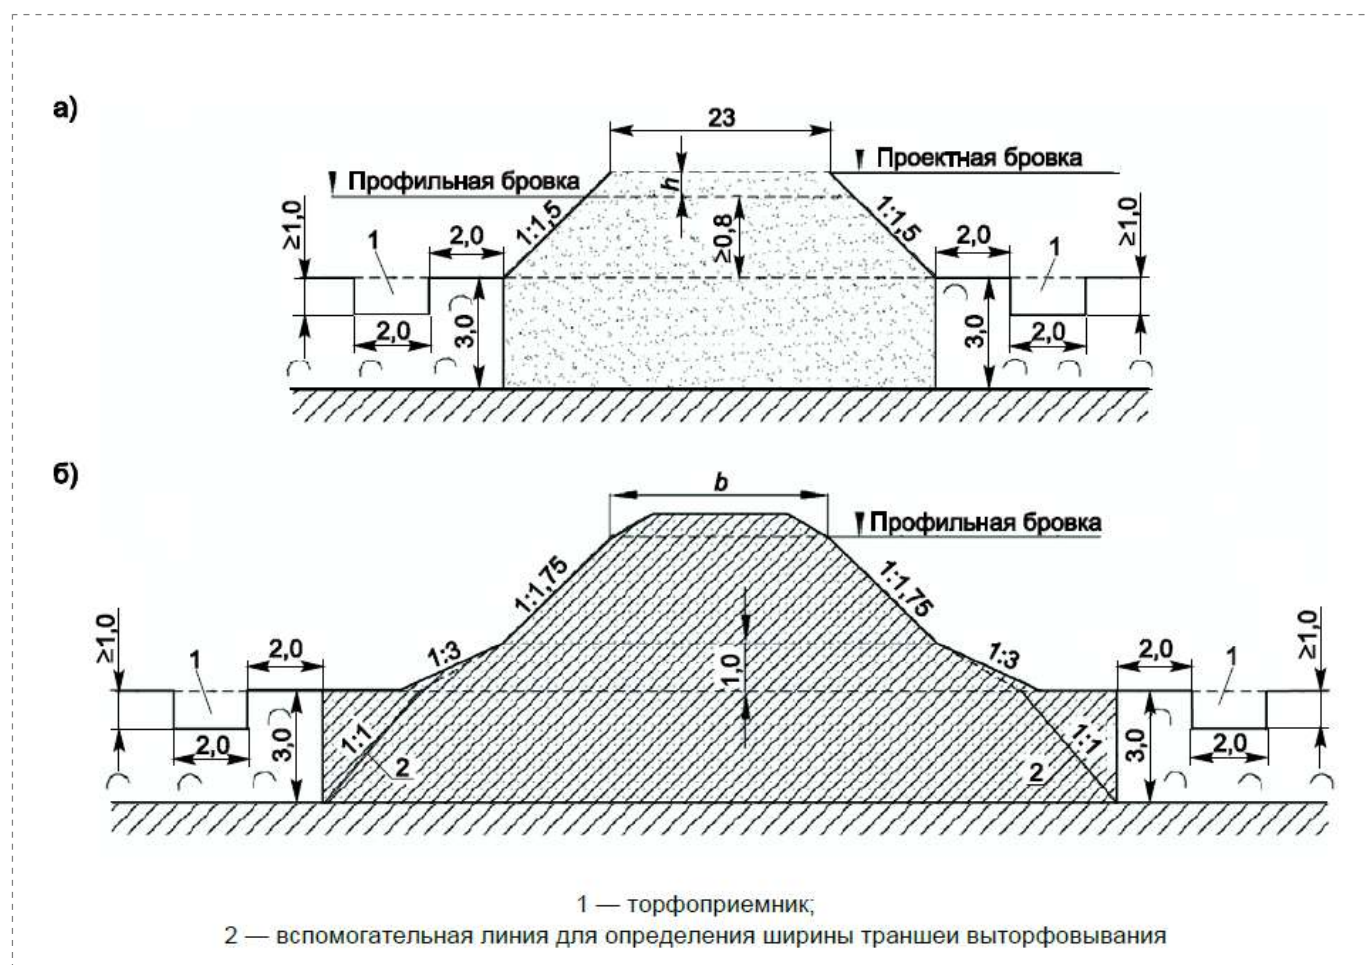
Поперечные профили насыпей на болотах II типа глубиной до 3 м при поперечном уклоне основания не круче 1:15:
